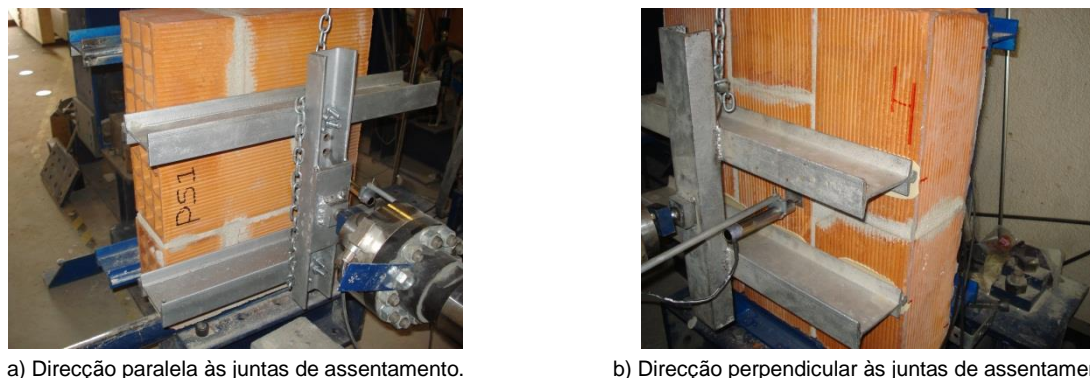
Vista dos provetes posicionados na máquina de ensaio.
